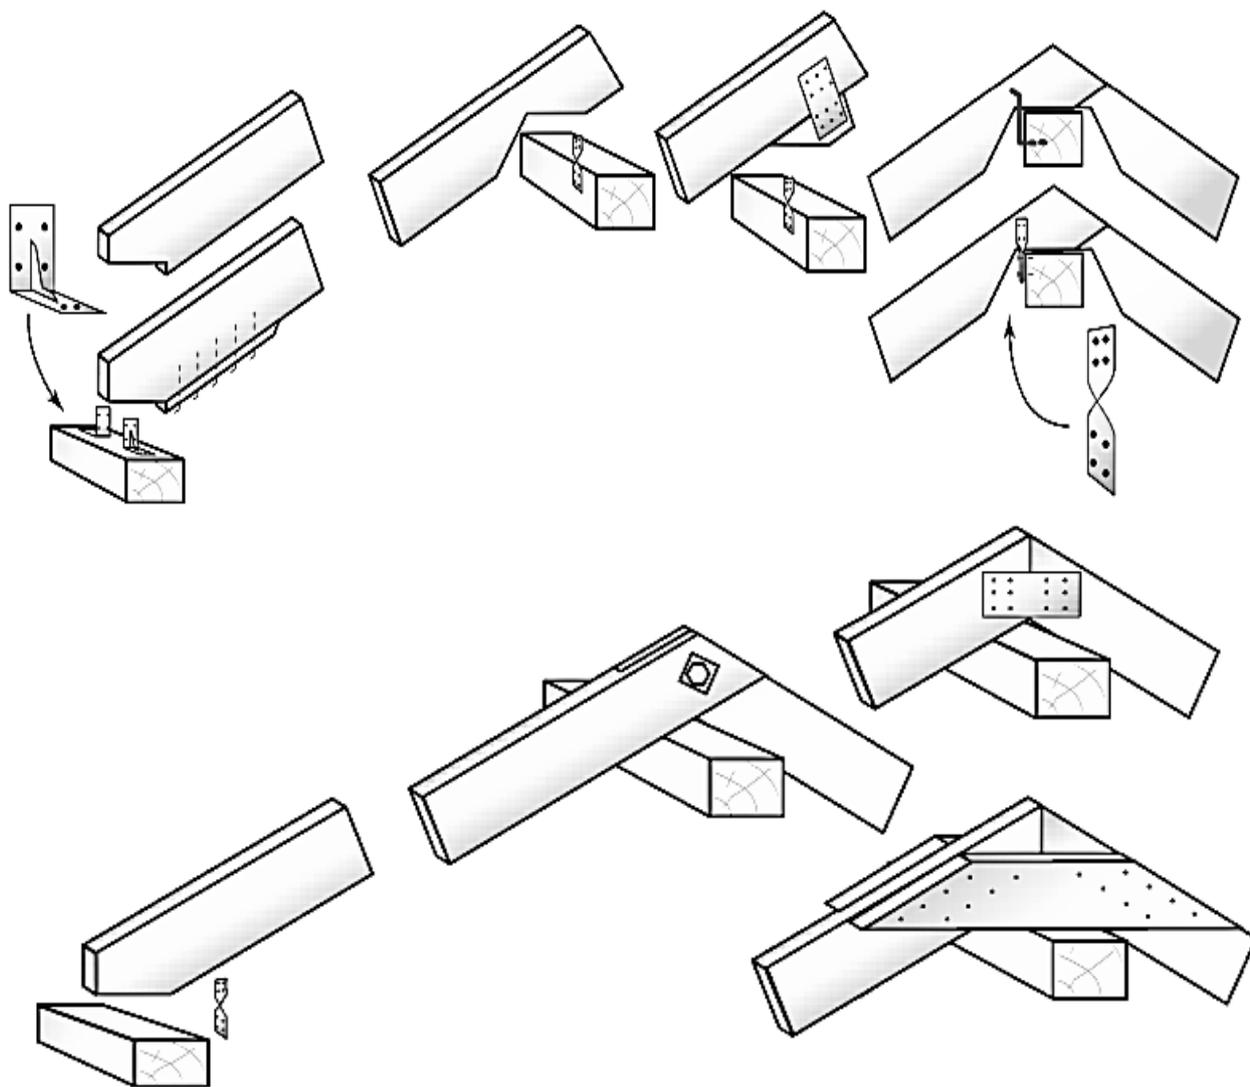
Безраспорные наслонные стропила без подкосов
